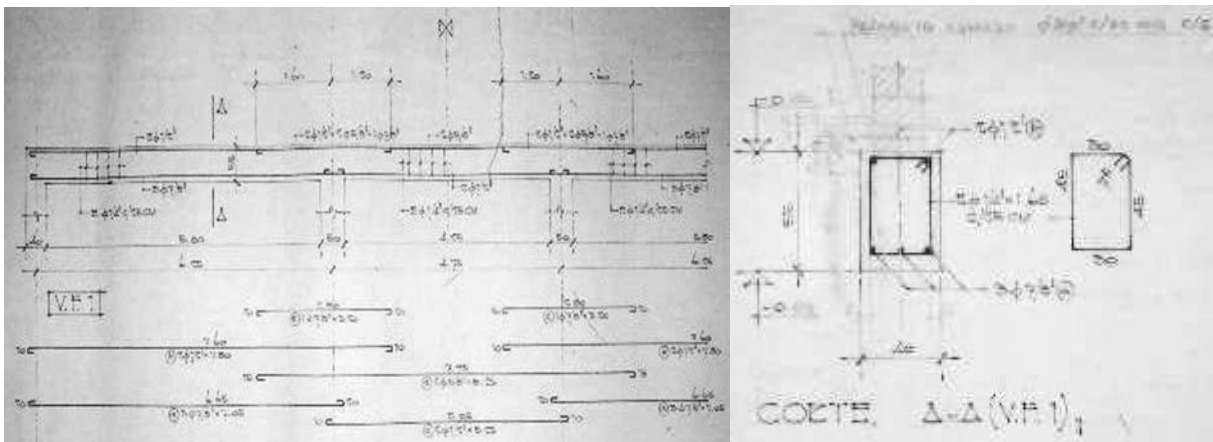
Detalles de la Viga V.F.1. Tipo Antiguo II
